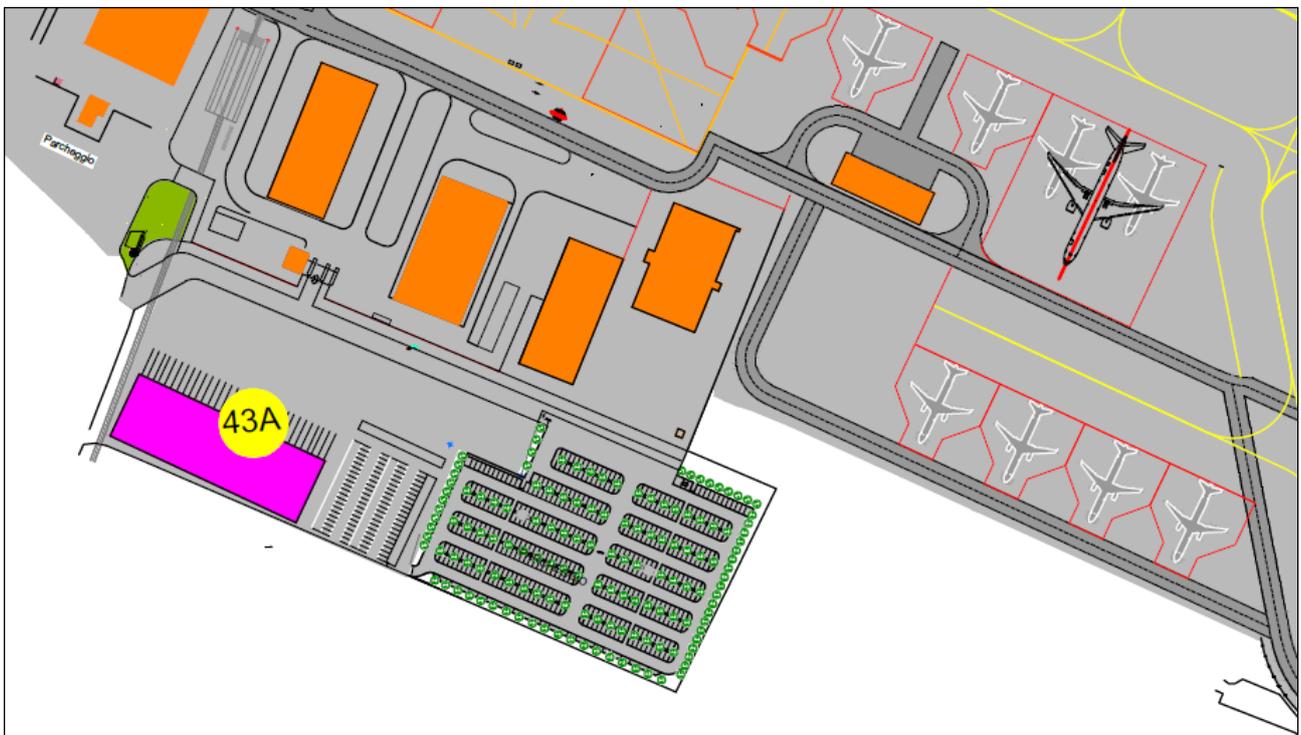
Estratto Master Plan – Edifici per Spedizionieri
